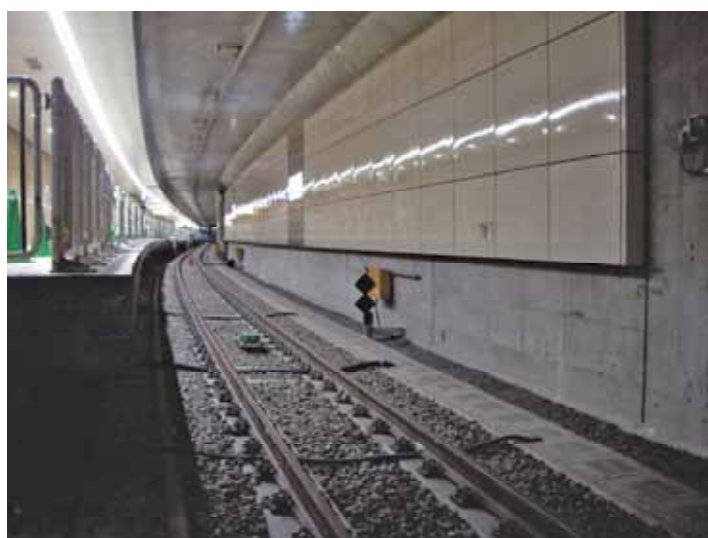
縦マクラギ（ラダー軌道）の設置状況
